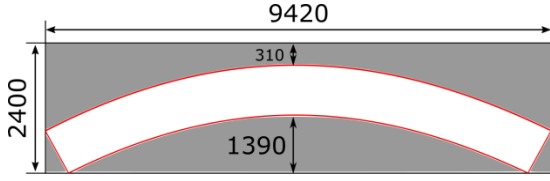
Vue en plan des tôles du fond préfabriqué
